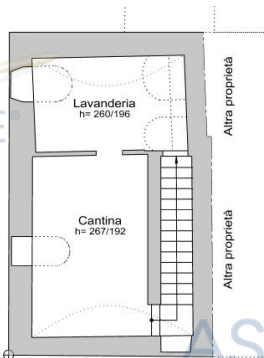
Rilievo piano interrato eseguito dalla CTU- estratto di Allegato A) Elaborati grafici
